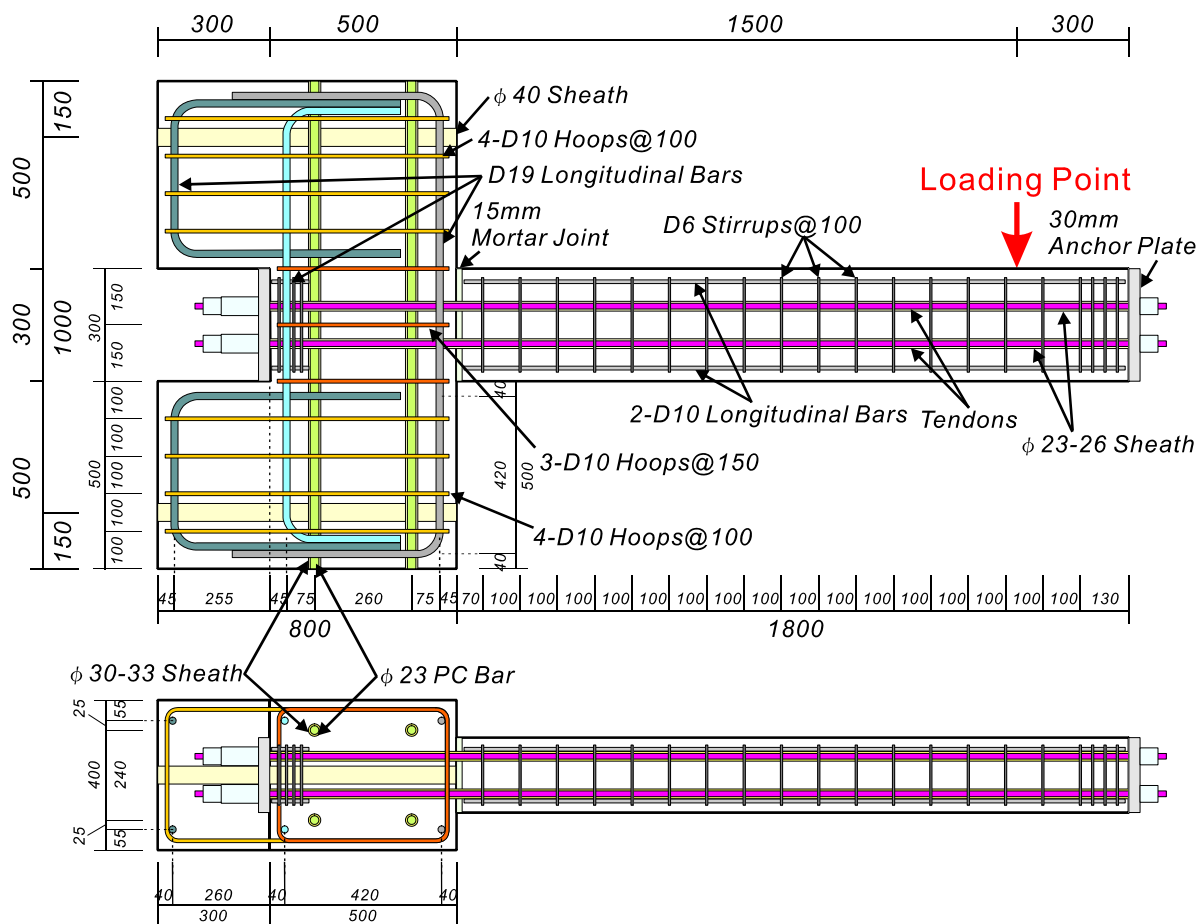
片持ち梁試験体詳細 (単位 : mm)
